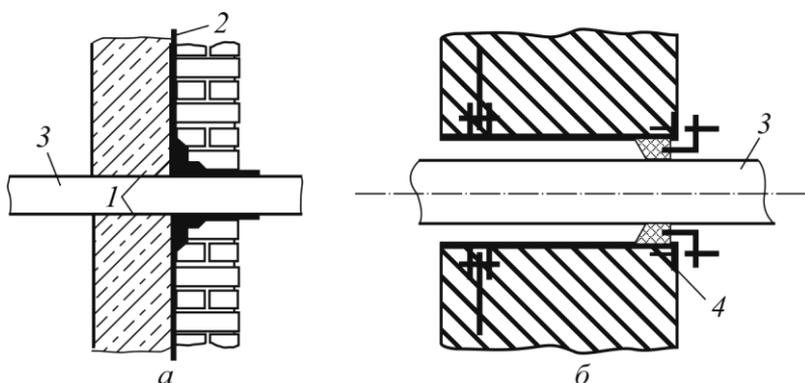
Гидроизоляция пропусков труб и кабелей: *а* – оклеенный пропуск, *б* – сальниковый пропуск; *1* – оклеенная гидроизоляция трубы; *2* – гидроизоляция стены; *3* – металлическая труба пропуска, *4* – сальниковая набивка
